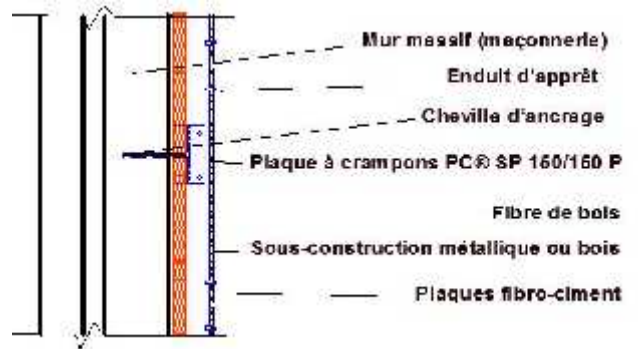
Détail n°04 :Détail de La façade ventilée(1/20)
